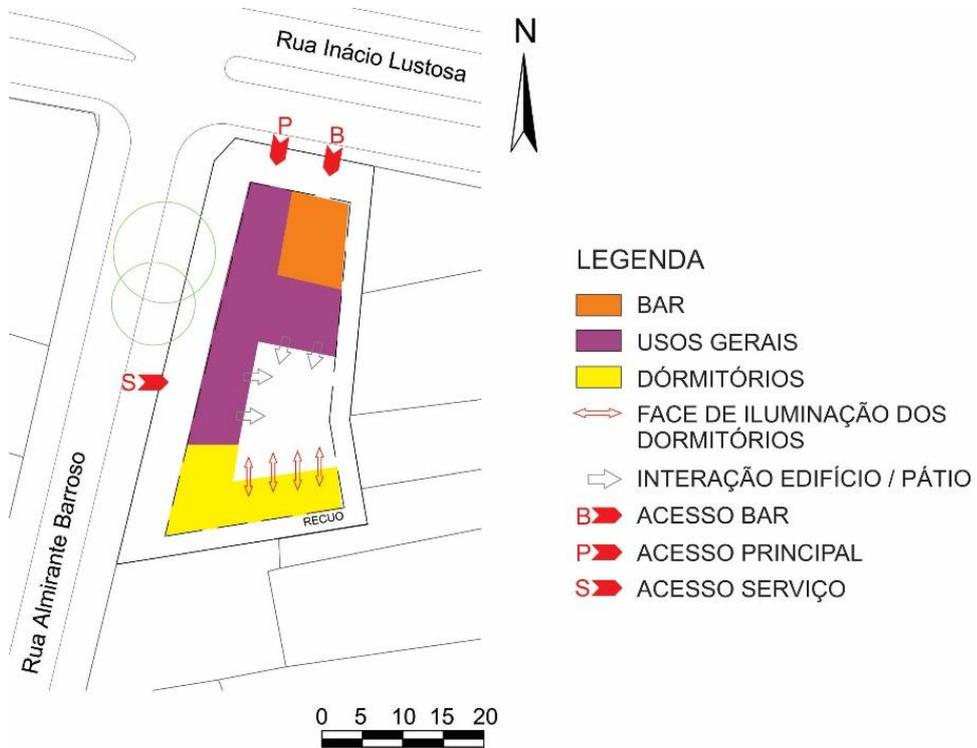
Proposta 4 de implantação. FONTE: A AUTORA (2016).
